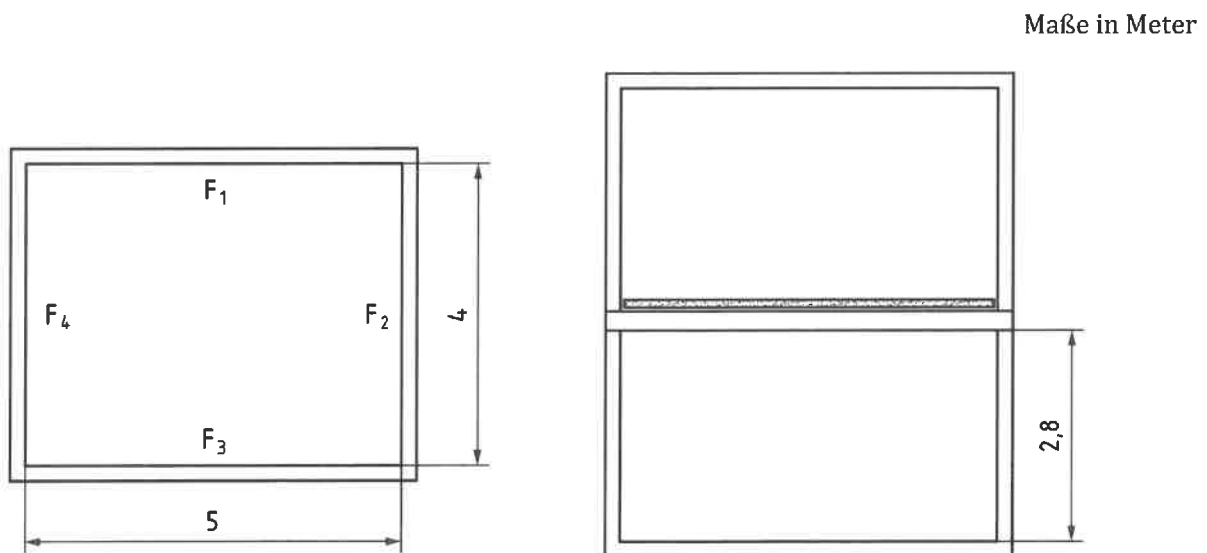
Grundriss (links) und Schnitt (rechts) zweier übereinanderliegender Räume im Holzbau (Prinzipskizze)
